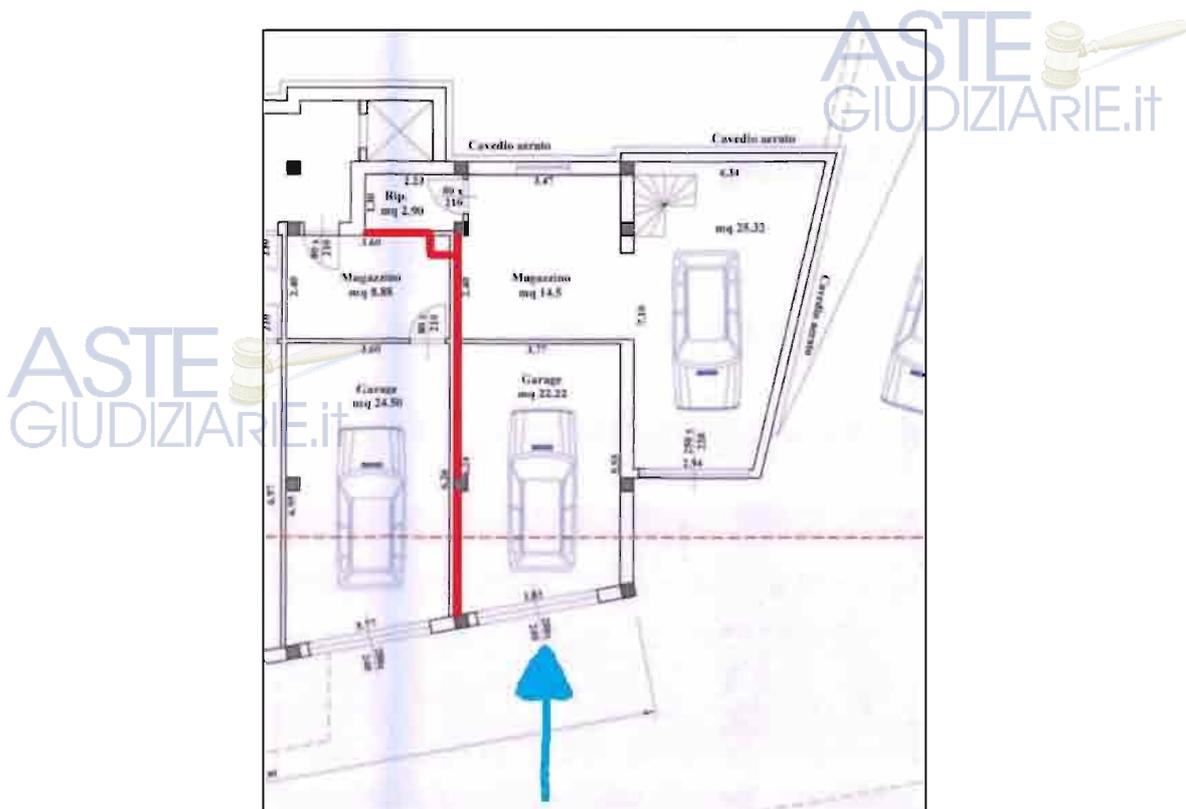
Immobile A\_21, autorimessa piano seminterrato (Planimetria di progetto)
